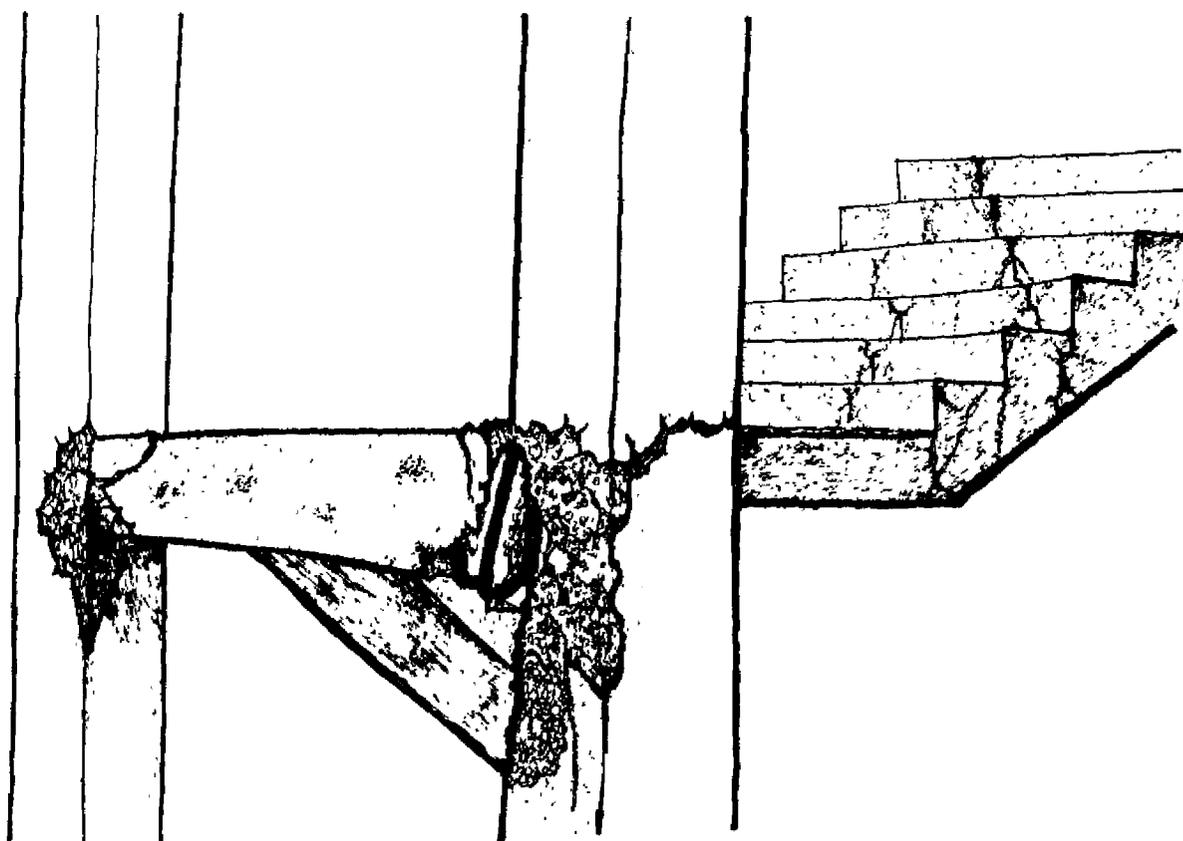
Daños en las columnas estructurales debido a la transmisión de fuerzas laterales a través de las gradas.
